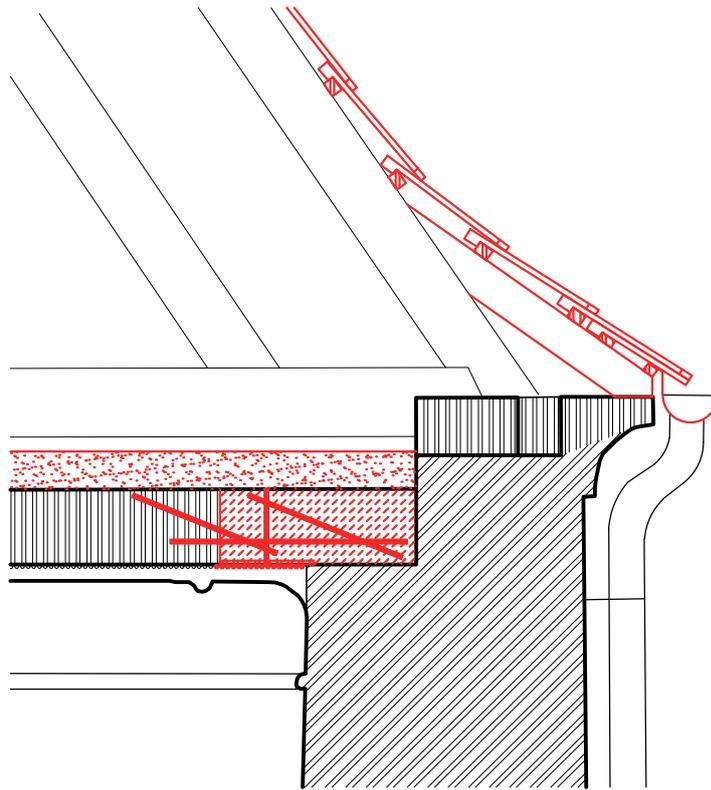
Vorschlag 1 zur Sanierung der Decke mit Polymerbeton und neuem Lehmschlag, Schnitt.
